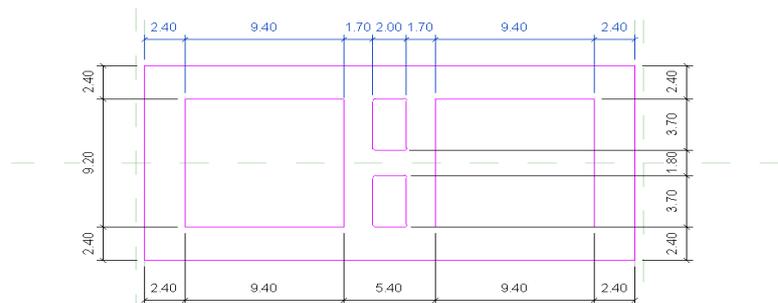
5 – Sobreposição e restrição das arestas laterais aos planos de referência.
